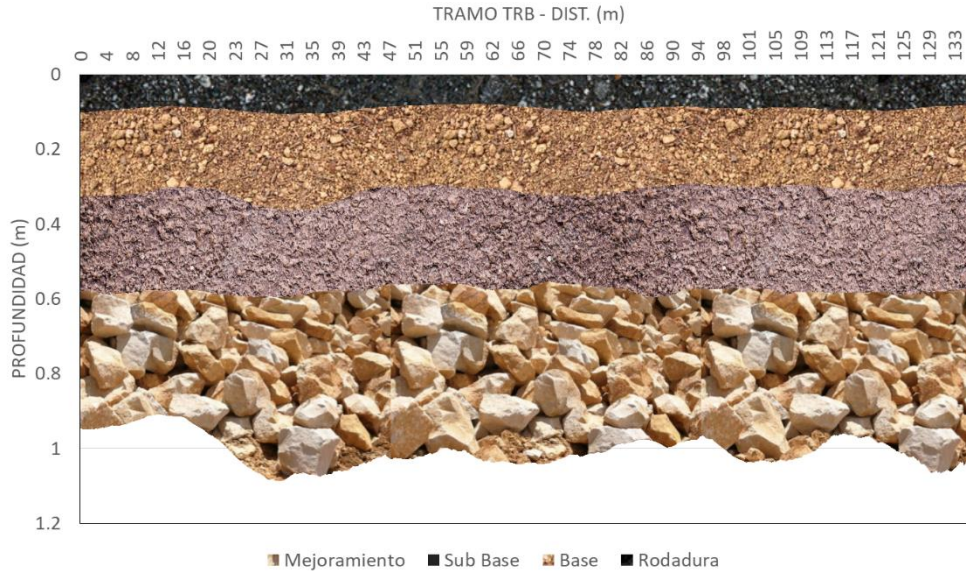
Espesores de capas de estructura de pavimento mediante GPR, tramo TRM.
